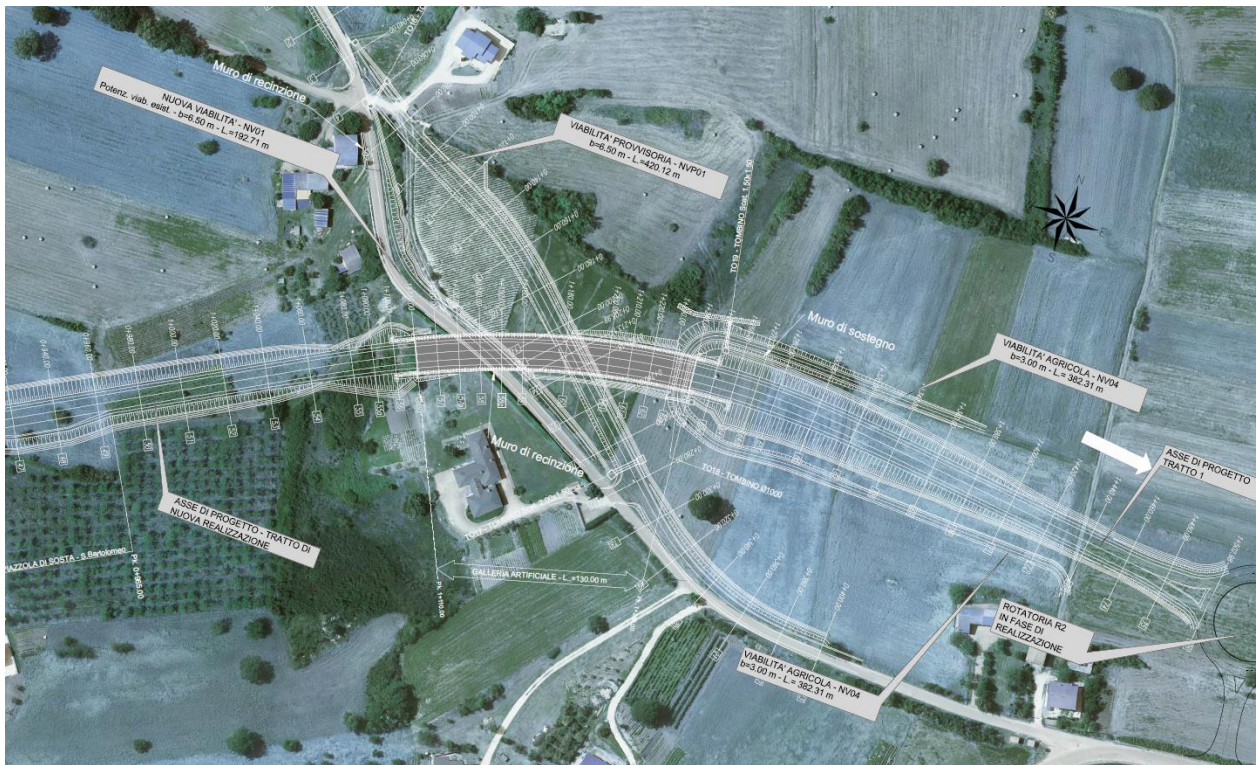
Stralcio galleria - Planimetria su ortofoto
